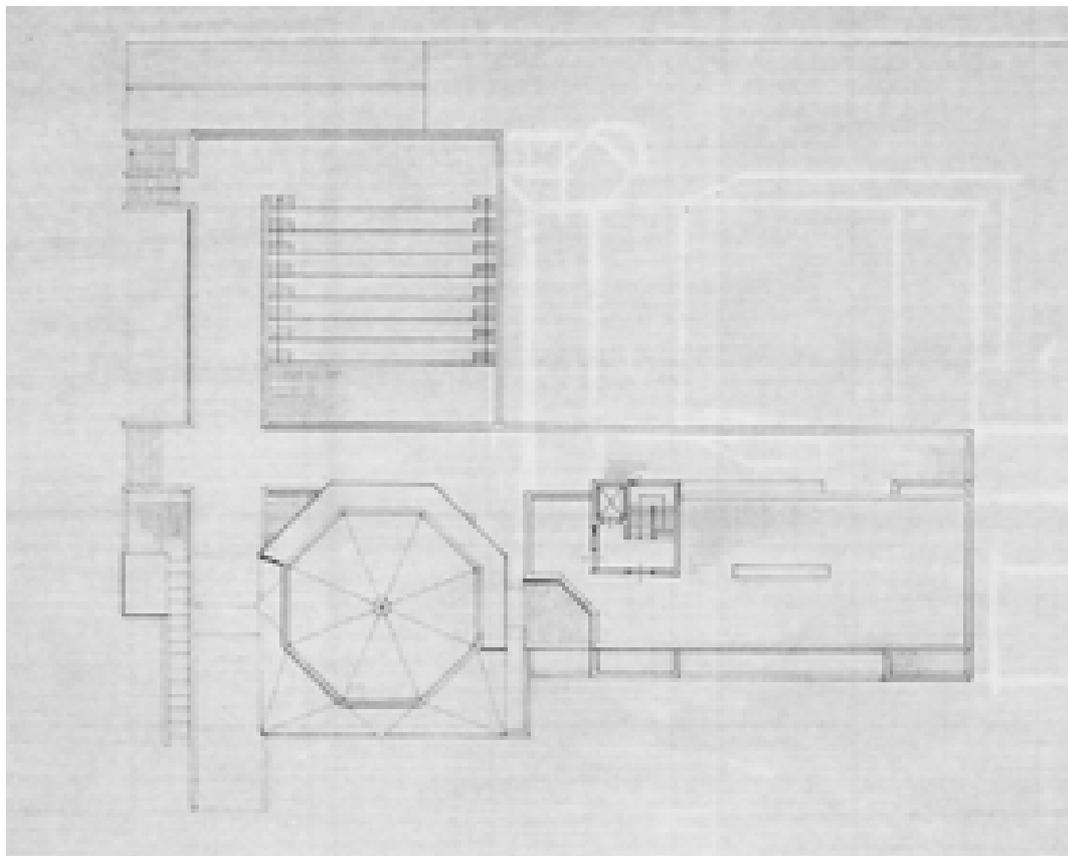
Pianta delle coperture, stato futuro – 23/06/1997 (AABS-64_955)
